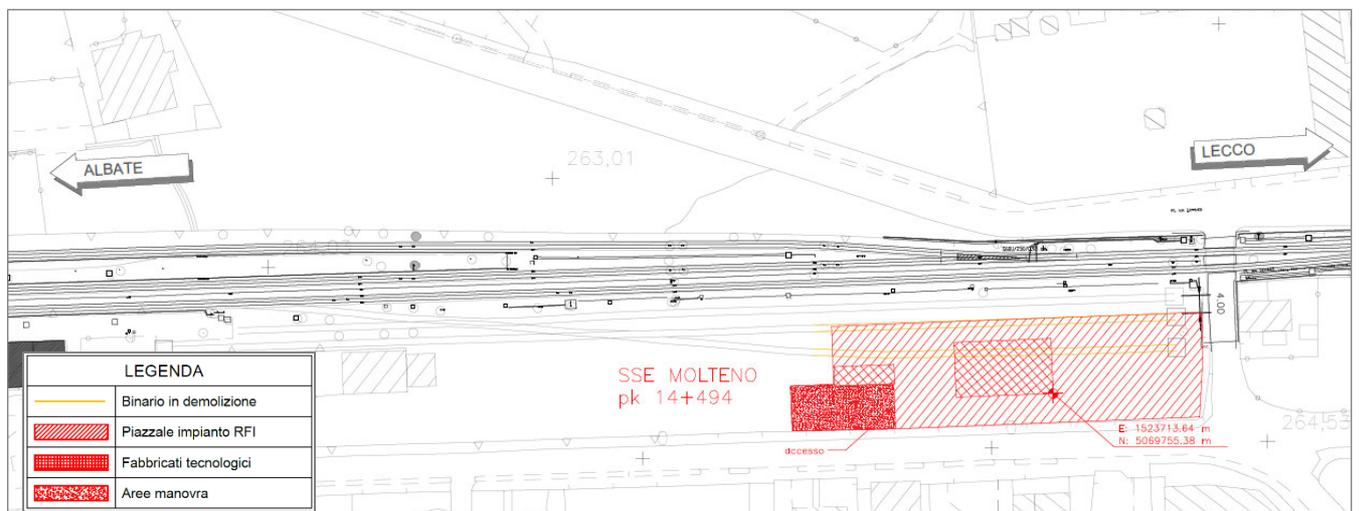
Planimetria di ubicazione nuova SSE Molteno
